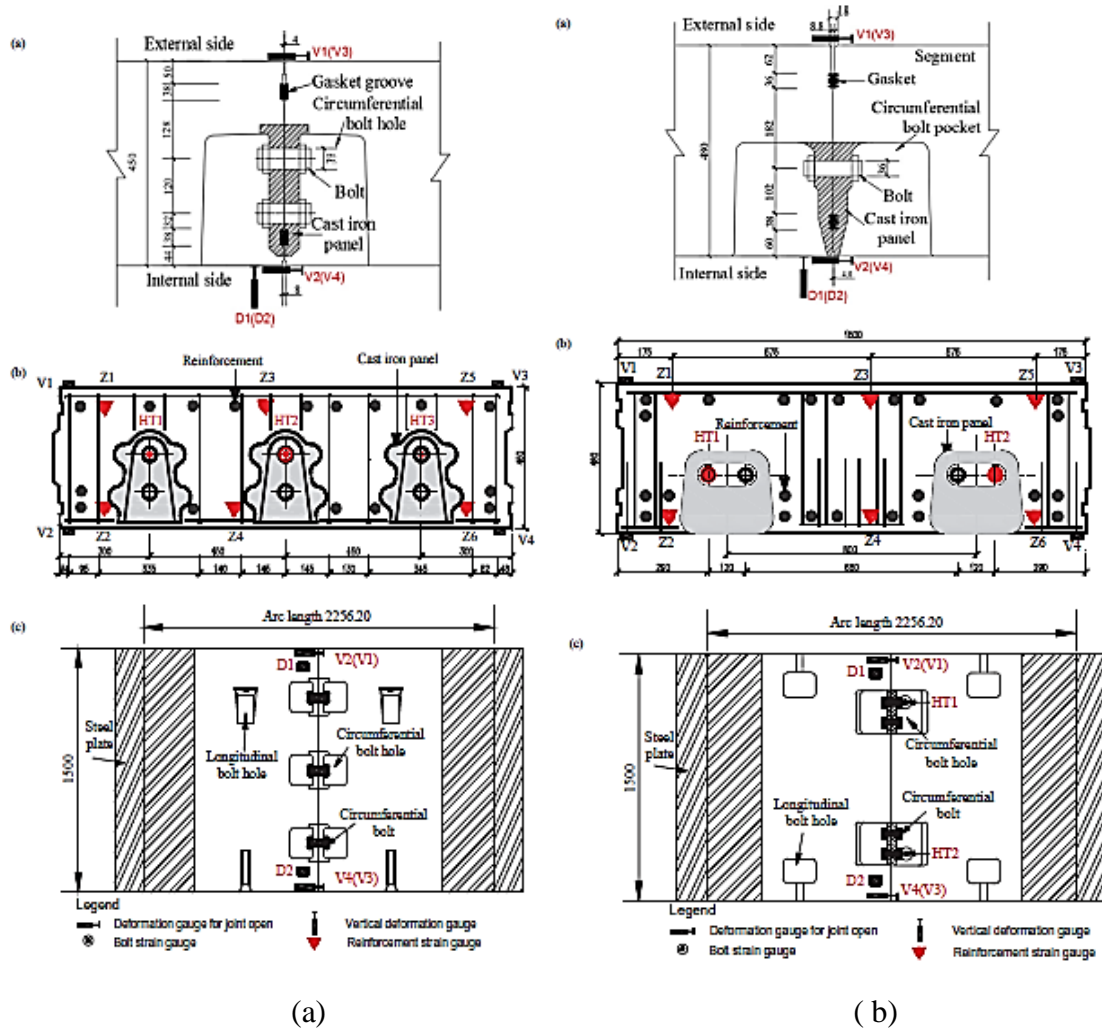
Géométrie des joints de tunnel (unité : mm): [i : sous rivièrè JR, ii : sous 30m de la surface de sol JL], (a) Section du joint, (b) Disposition des jauges de contrainte pour les joints, (c) montage pour le joint (Jin et al. 2017)
